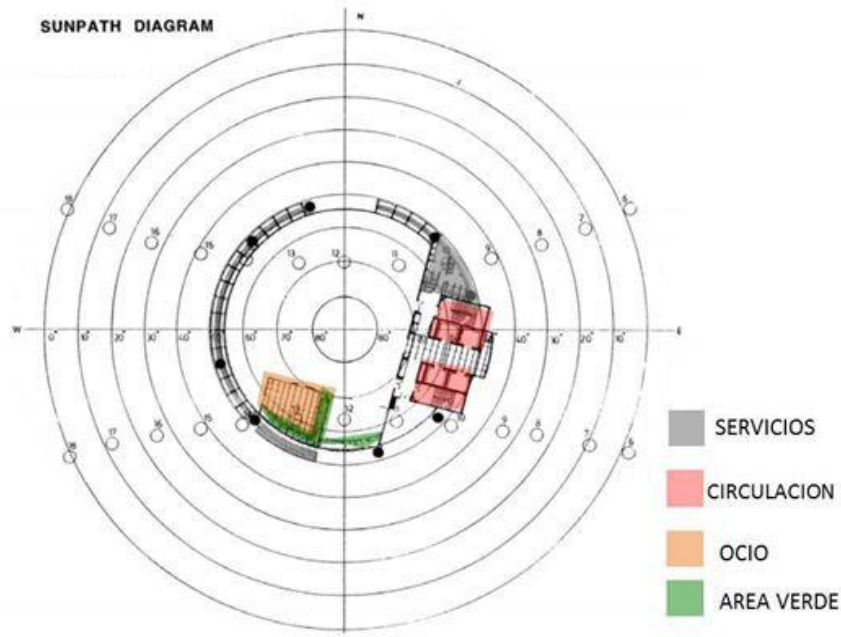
Planta y Zonificación de Torre Menara. Fuente: Sachahuaman, Sandra. Arquitectura.blogspot
